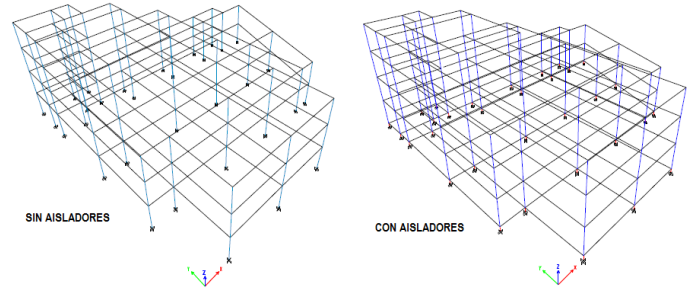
Vista en planta de los bloques estructurales del nuevo Centro de Investigaciones Científicas y de Post Grados. A la izquierda se muestra el diseño sin aisladores y a la derecha con aisladores.
